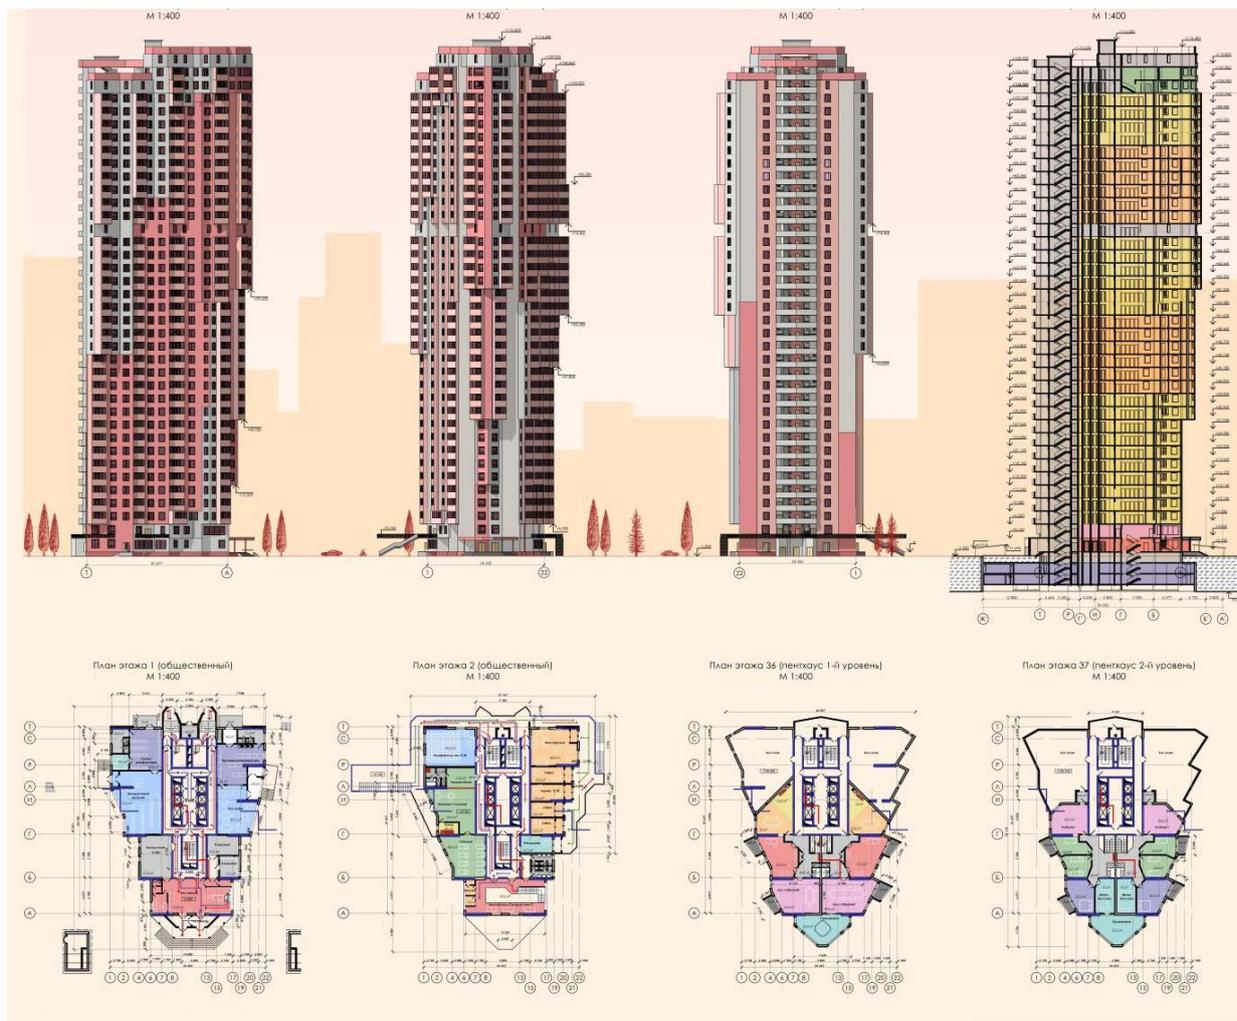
Основные фасады, планы, разрезы проектируемого здания.
